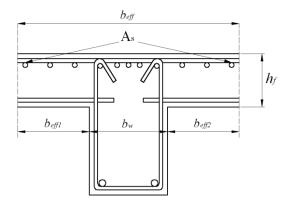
Расположение растянутой арматуры неразрезных балок в сечении полки
